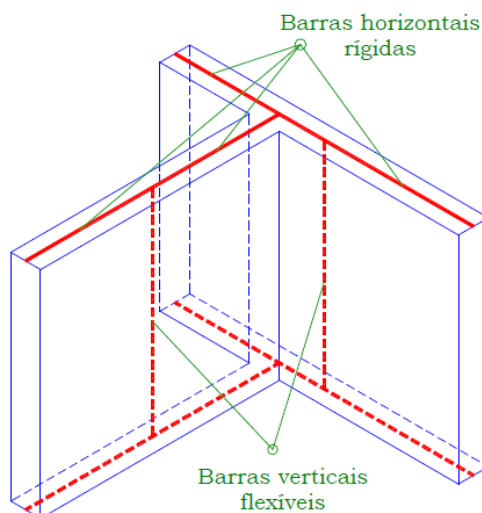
Modelagem das paredes do pórtico tridimensional. Fonte: Nascimento Neto (1999).
